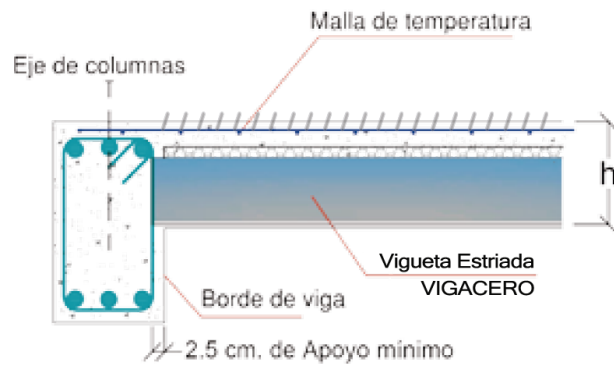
Detalle constructivo de encuentro con viga peraltada exterior
